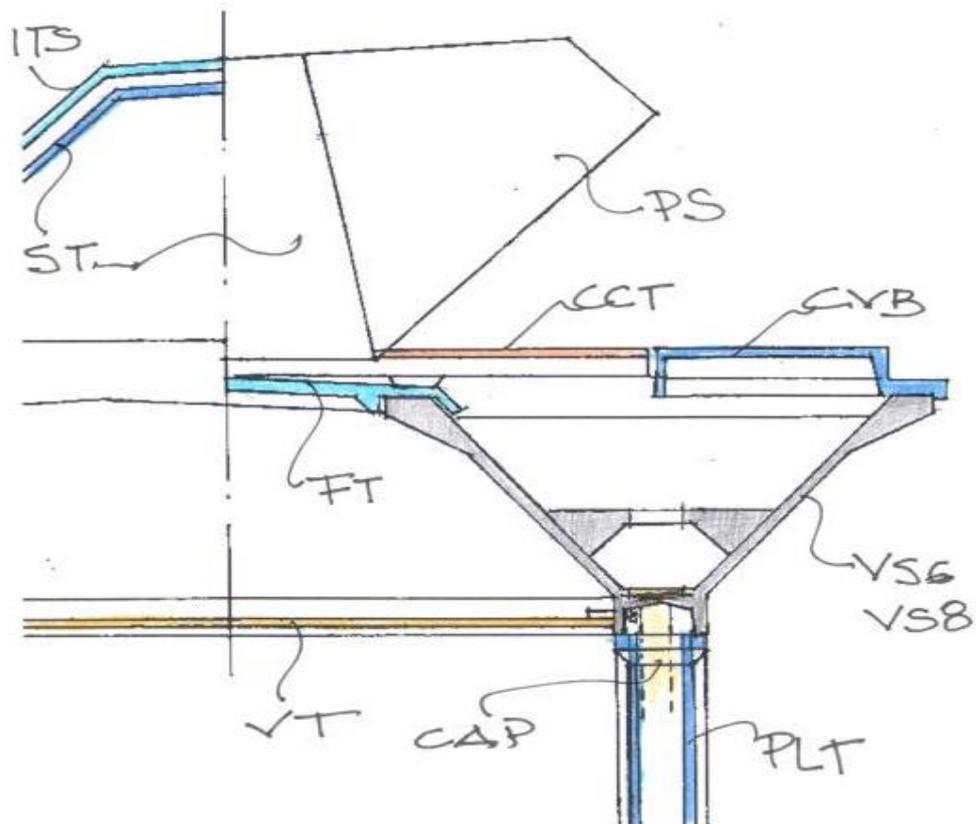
Corte Longitudinal do Módulo Tipo, detalhe lateral. Desenho do autor.
